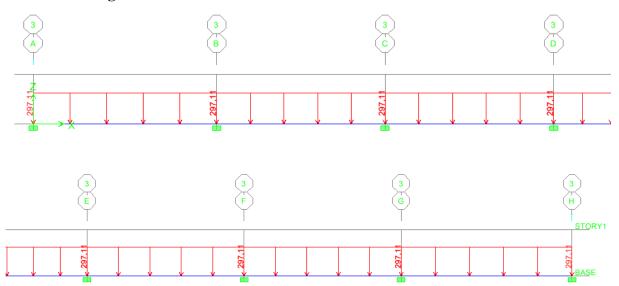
Schéma statique de la nervure ELU (sens longitudinal).
